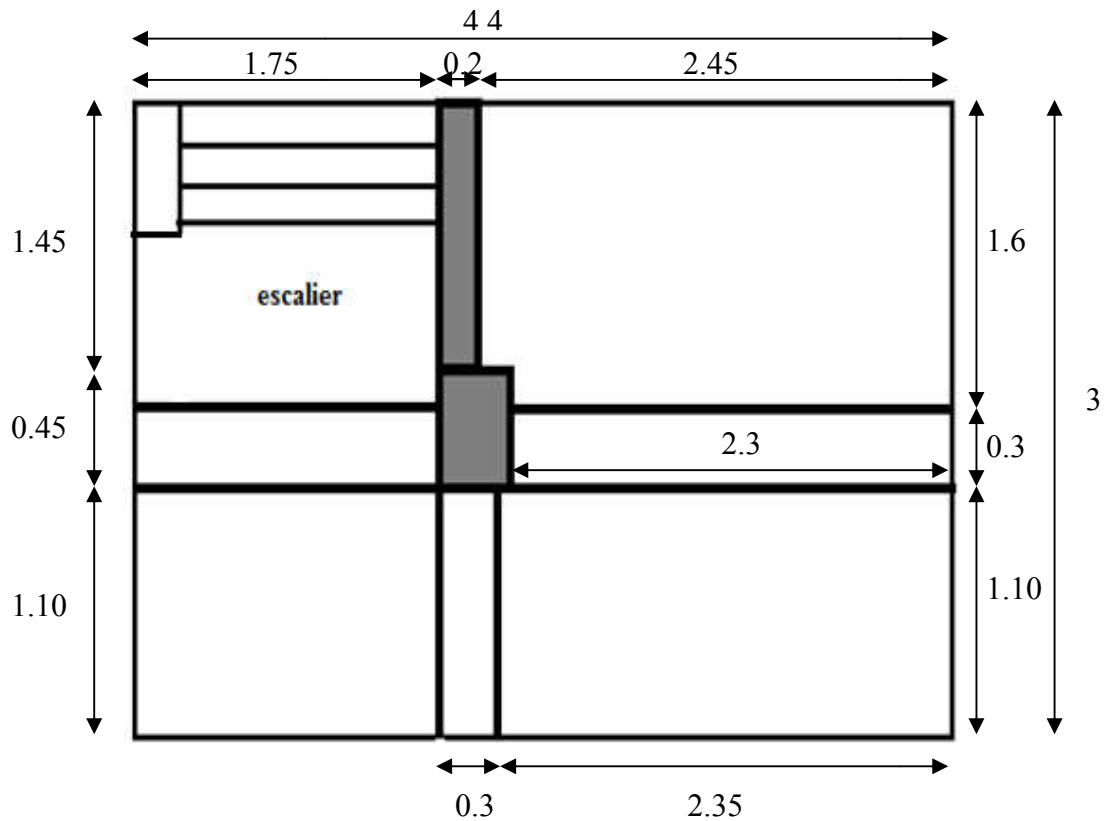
Les sections entourées par le poteau de la cage d'escalier à l'étage
